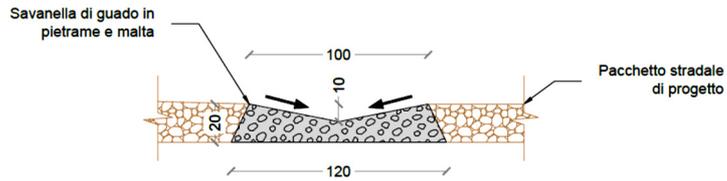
Sezione "Tipo" canaletta di drenaggio realizzata in scavo
